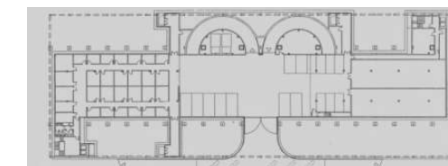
Planta baja del Mercado de la Concepción Barcelona
